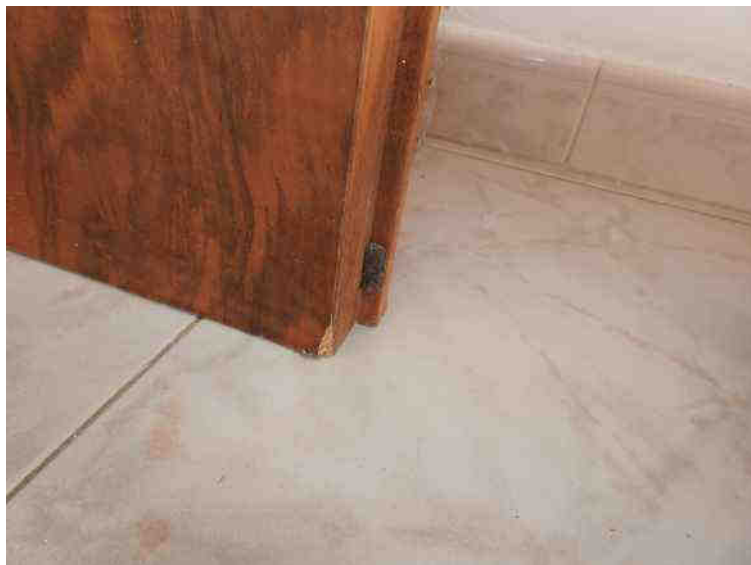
Rigonfiamento spigolo inferiore (stanza 3)
